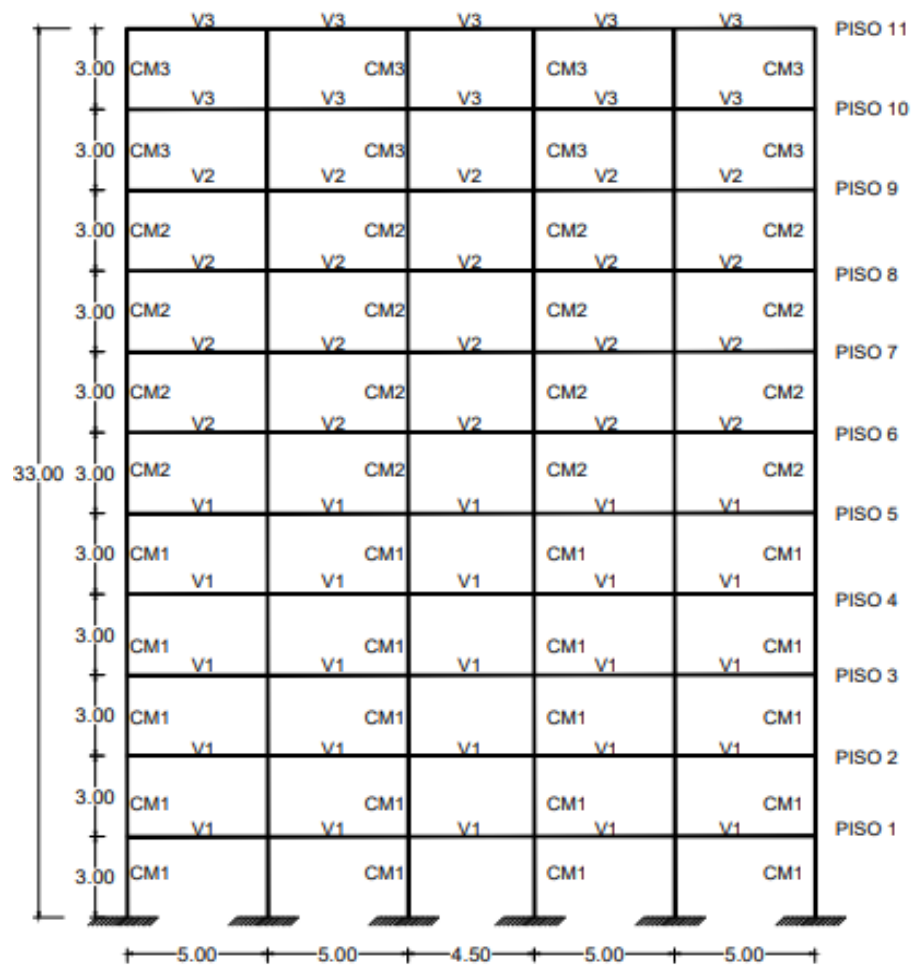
Esquema de pórtico a ser analizado en elevación – Edificio 11 pisos
